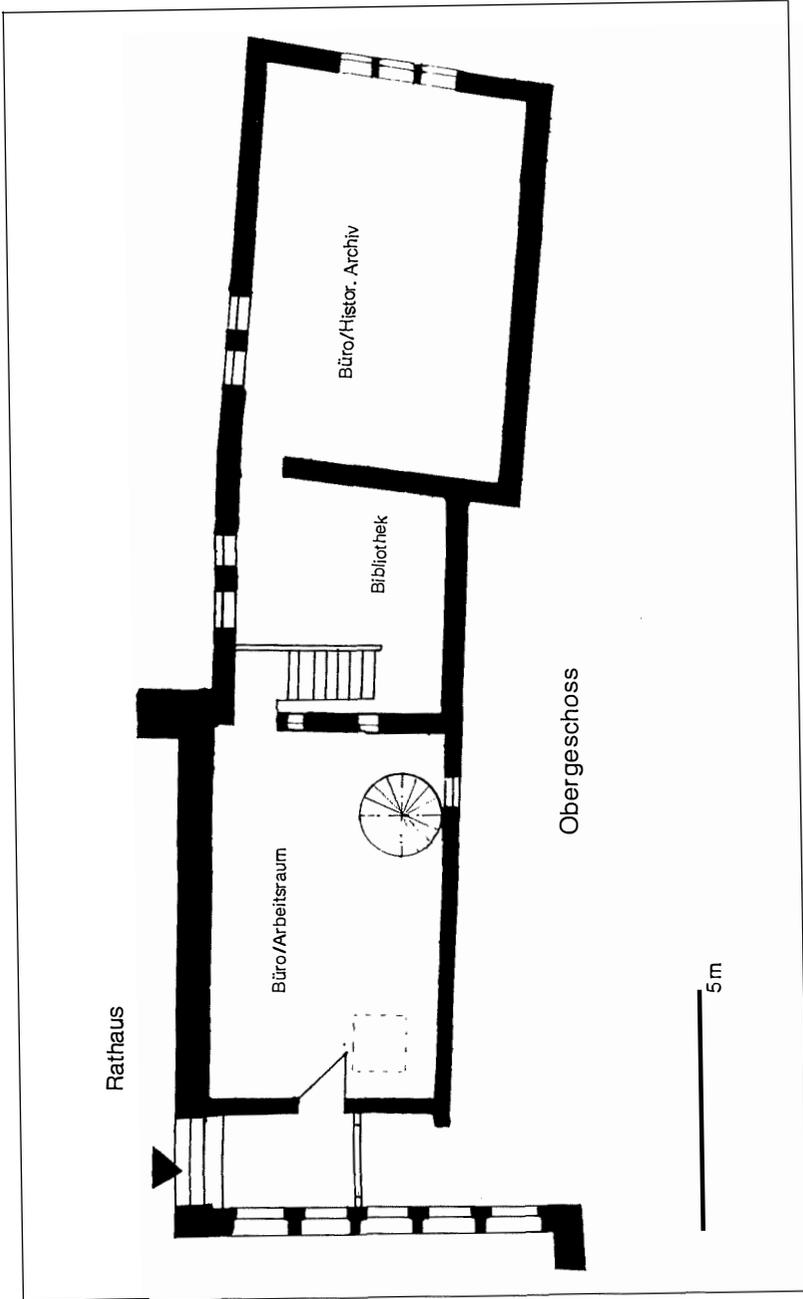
Stadtarchiv Goch, Anbau an das Rathaus. Obergeschloß-Grundriß.
